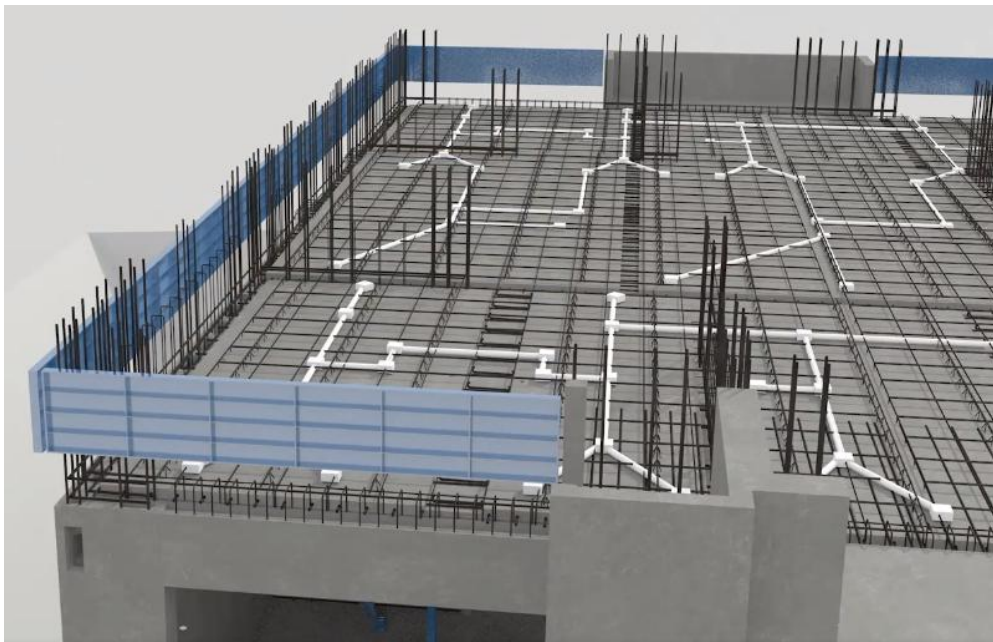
阳台、叠合楼板上铁钢筋、边模板安装
